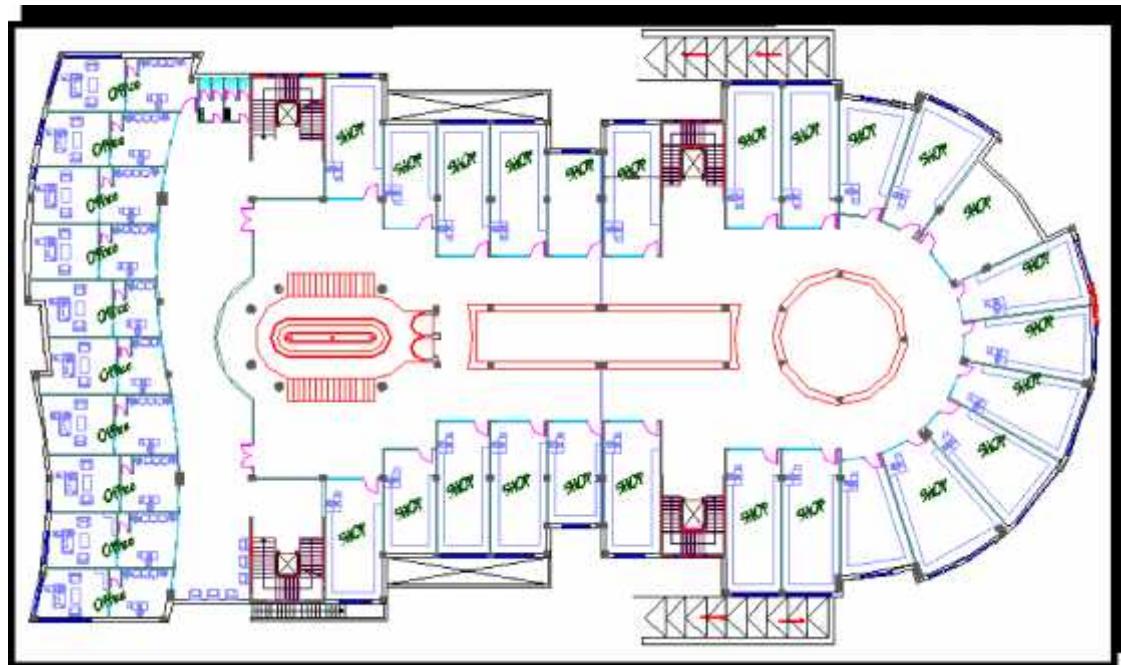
المسقط الأفقي للطابق الأرضي
